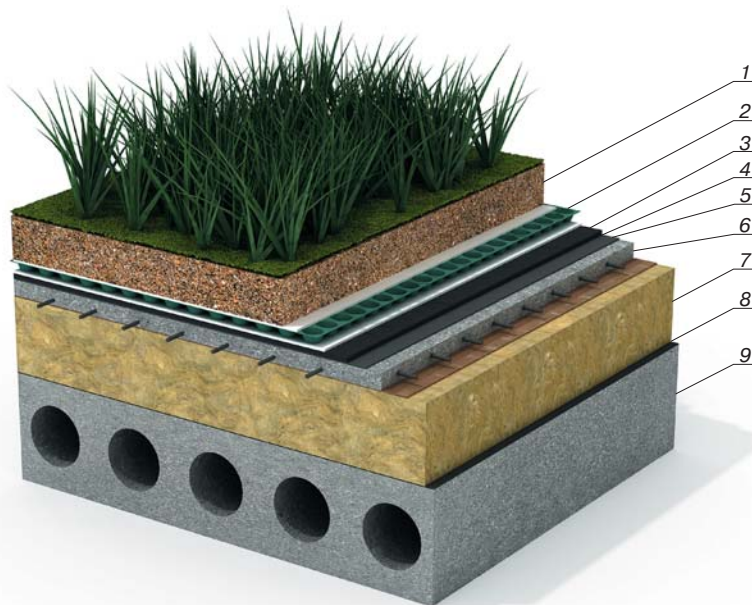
Макет фрагмента зеленой кровли: 1 – грунт; 2 – геотекстиль – геодренажная сетка; 3 – Техноэласт Грин; 4 – нижний слой гидроизоляции (Техноэласт ЭПП); 5 – битумный праймер; 6 – армированная цементно-песчаная стяжка; 7 – утеплитель; 8 – пароизоляция; 9 – бетонное основание.
